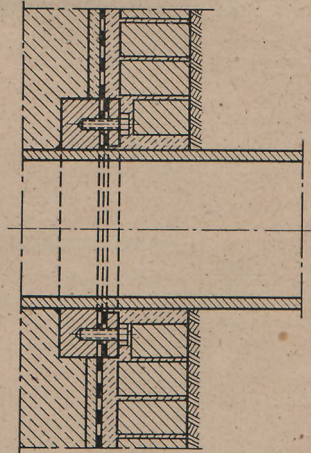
Durchführung einer Rohrleitung durch eine Dichtung
